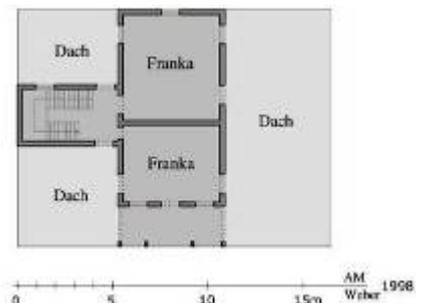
Bayt Ġabrī [988], Grundriss Dach
